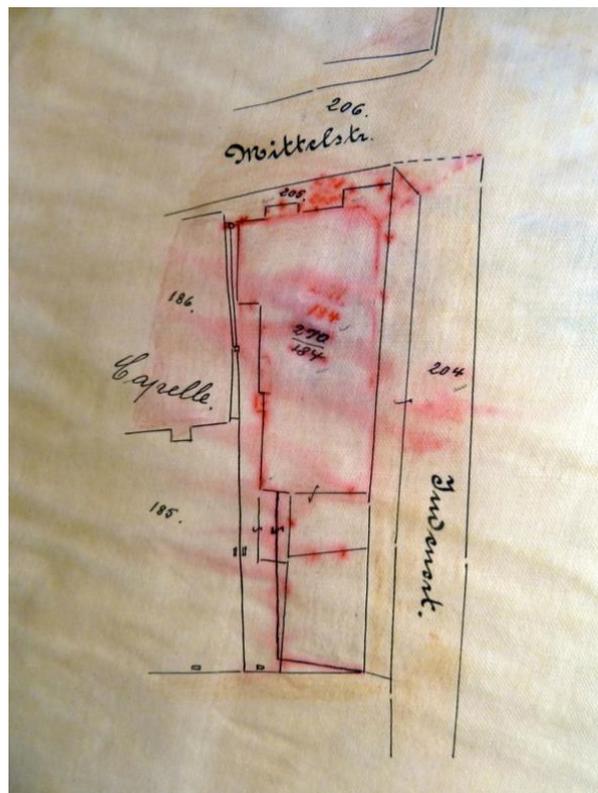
Plan des Eckgebäudes Mittelstraße – Im Ort (im Plan „Judenort“)
